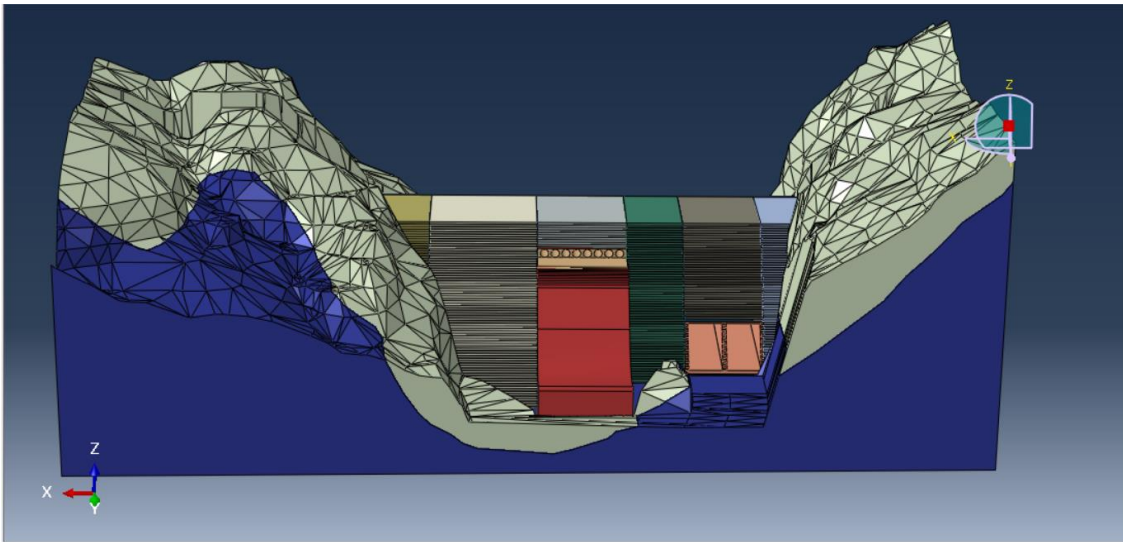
Geometría tridimensional de la cortina de la presa Pilares en la etapa 6 de construcción, en la elevación 200.00 msnm.
